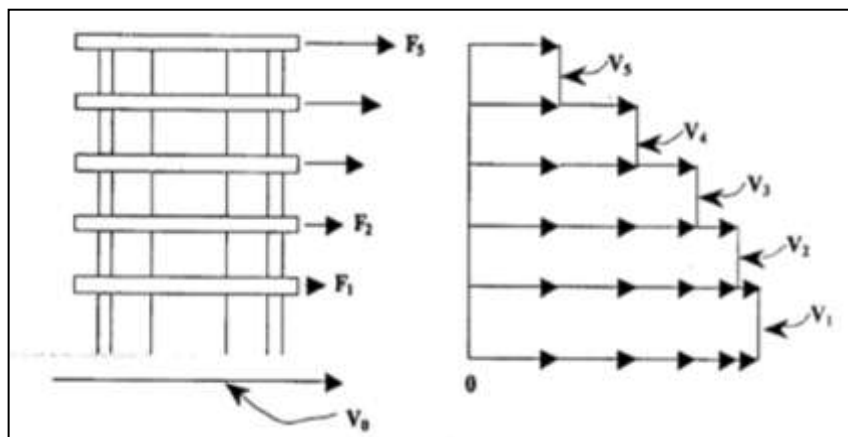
Cálculo del cortante de piso y en la base; Fuente: (NSR-10, 2010)
